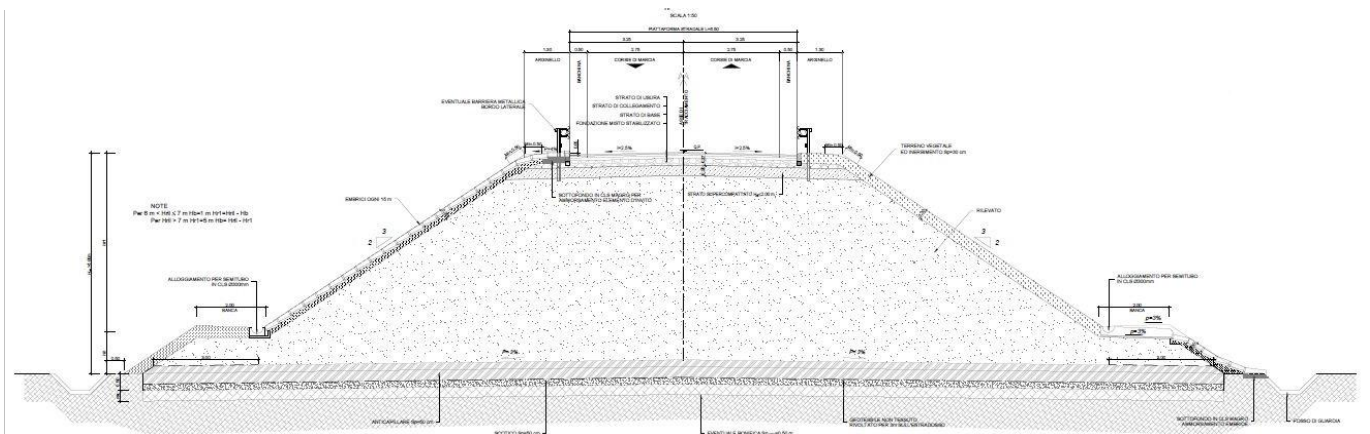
Dest. Particolare 6.5m - sezione tipo in rilevato $H_{r1} > 6.00$ m
